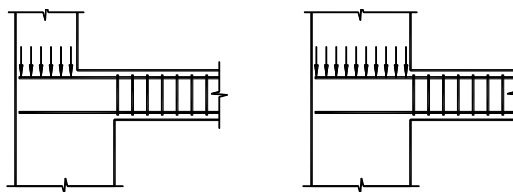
Влияние сжатия колонны на сцепление с бетоном горизонтальных стержней арматуры, проходящих через узел соединения балок с колоннами
